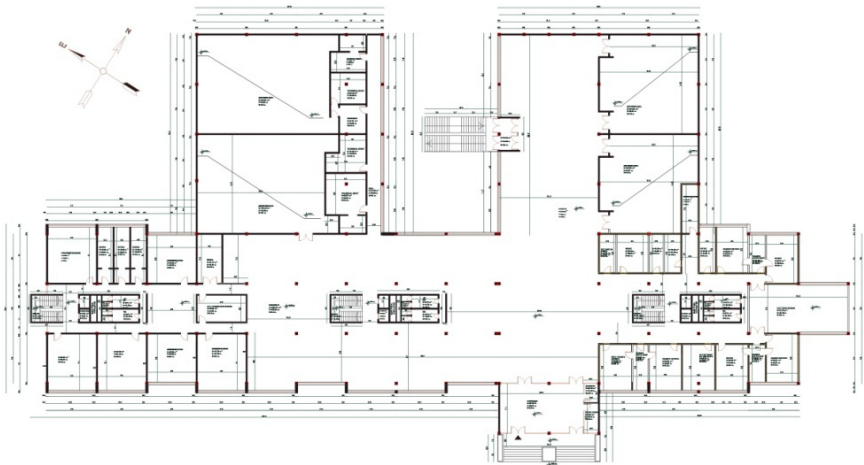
Planimetria e katit përdhesë – hyrja në ndërtesën e FT-së
